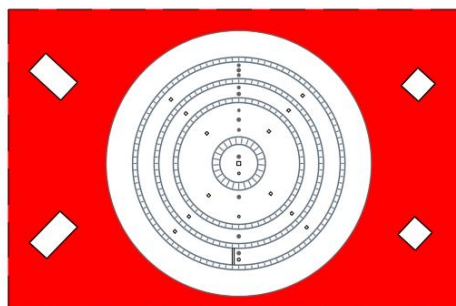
Planta: Área de rojo indica el sector a retirar de baldosas de concreto de 40x40cm.
